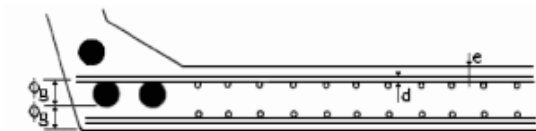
| 6 – Espessura mínima do banzo inferior para garantir o recobrimento das armaduras e boas condições de ancoragem [10]
